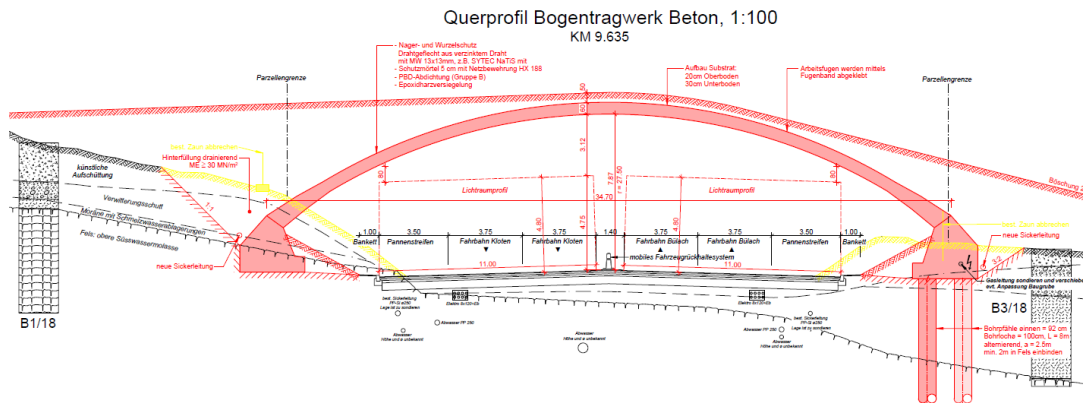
Stahlbetonvariante der Wildtierbrücke mit Bogentragwerk (Preisig AG, 2021).
